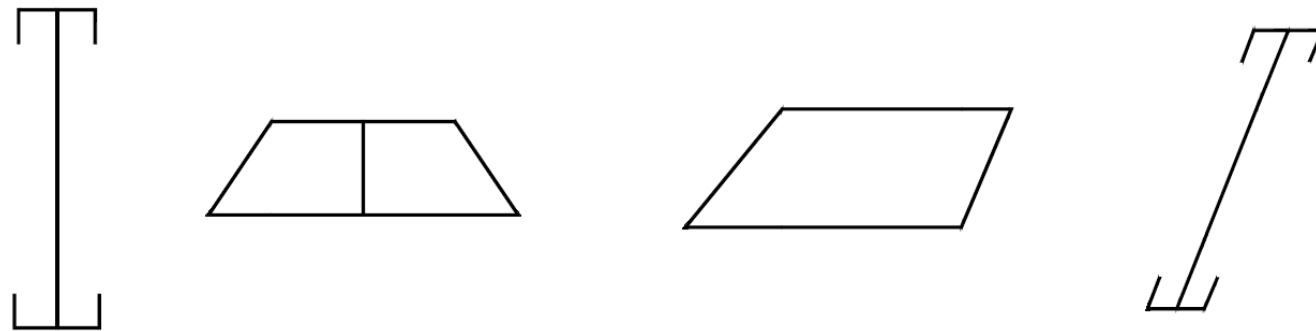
SECCIONES TIPO DEL ARCO METÁLICO.
